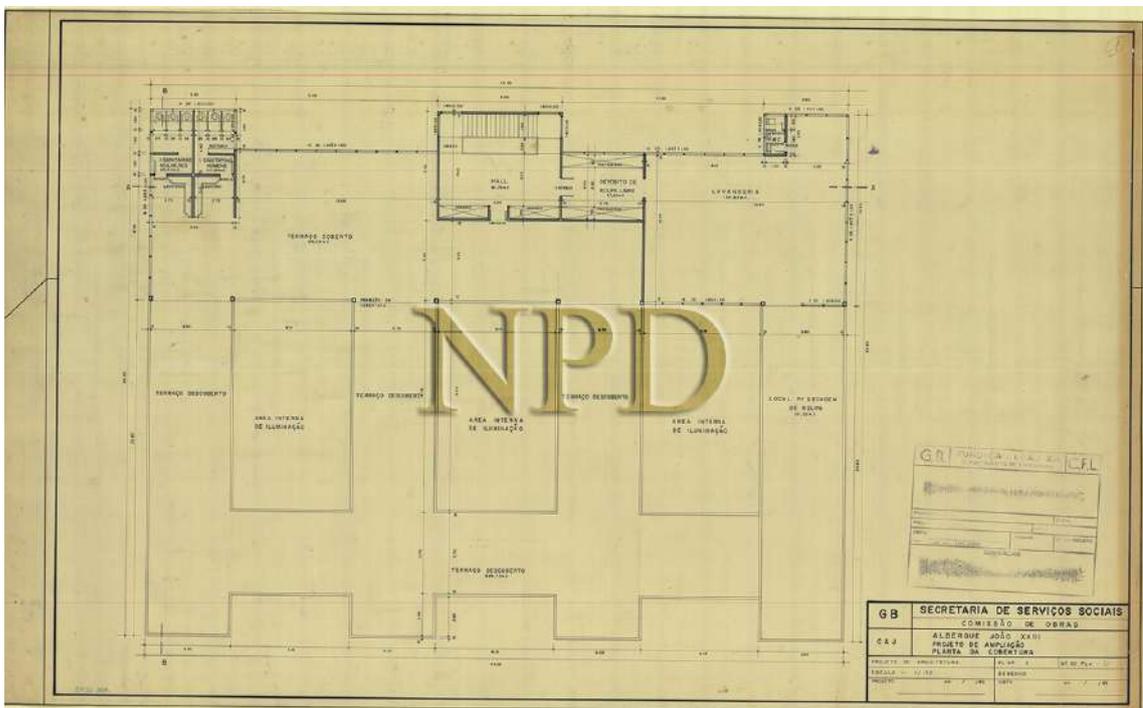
Proposta de acréscimo de cobertura sobre o 3º pavimento
